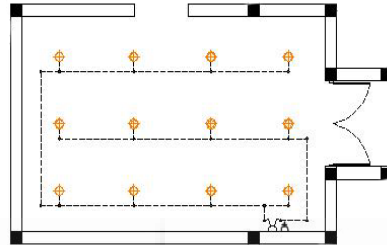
Rekomendasi Denah Titik Lampu Ruang Pamer
